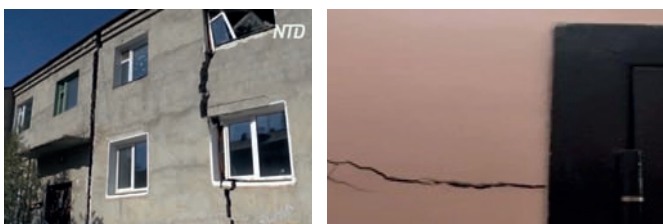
Примеры разрушения домов из-за таяния вечной мерзлоты: трещины в фасадной; трещины в стенах квартиры на первом этаже дома в элитном 203 микрорайоне Якутска
